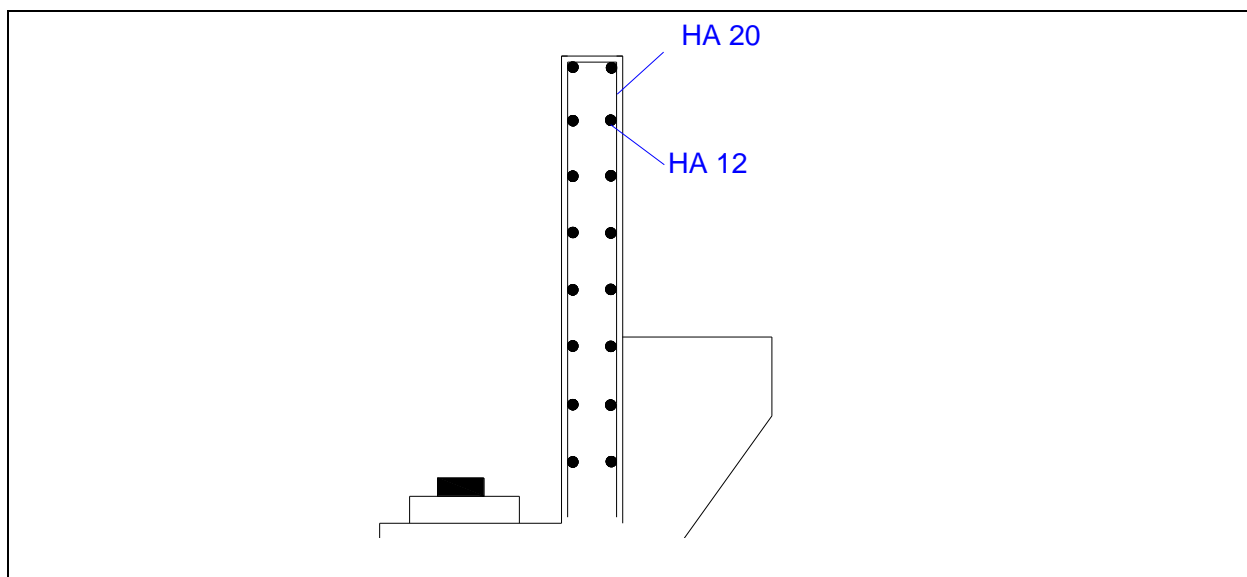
Ferrailage du mur garde grève et du corbeau d'appui
